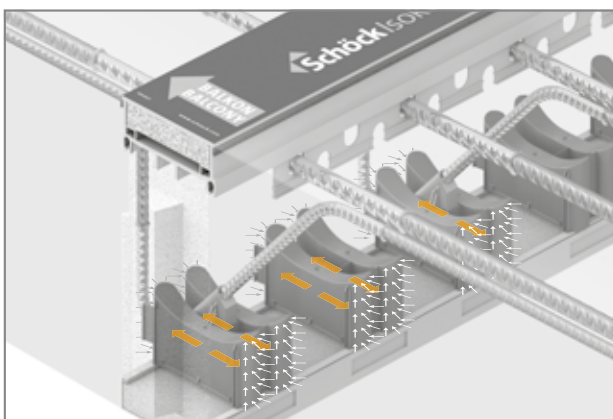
Schöck Isokorb® T typ KL: Příprava bednění a výztuže před betonáží; úroveň pracovní spáry - stěna = úroveň bednění - spodní hrana balkónové desky!
